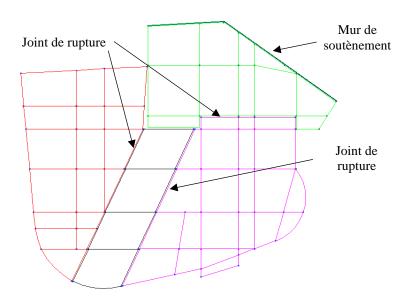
trame structurale de l'équipement. Source : Auteur.
